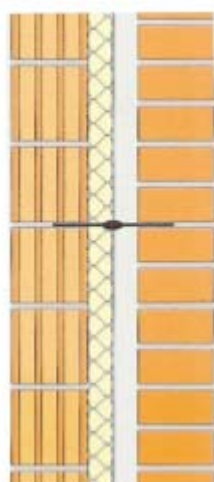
Fachada ventilada com isolamento térmico contínuo e pano exterior em tijolo maciço face à vista (Mesquita, Daniel, 2008)
